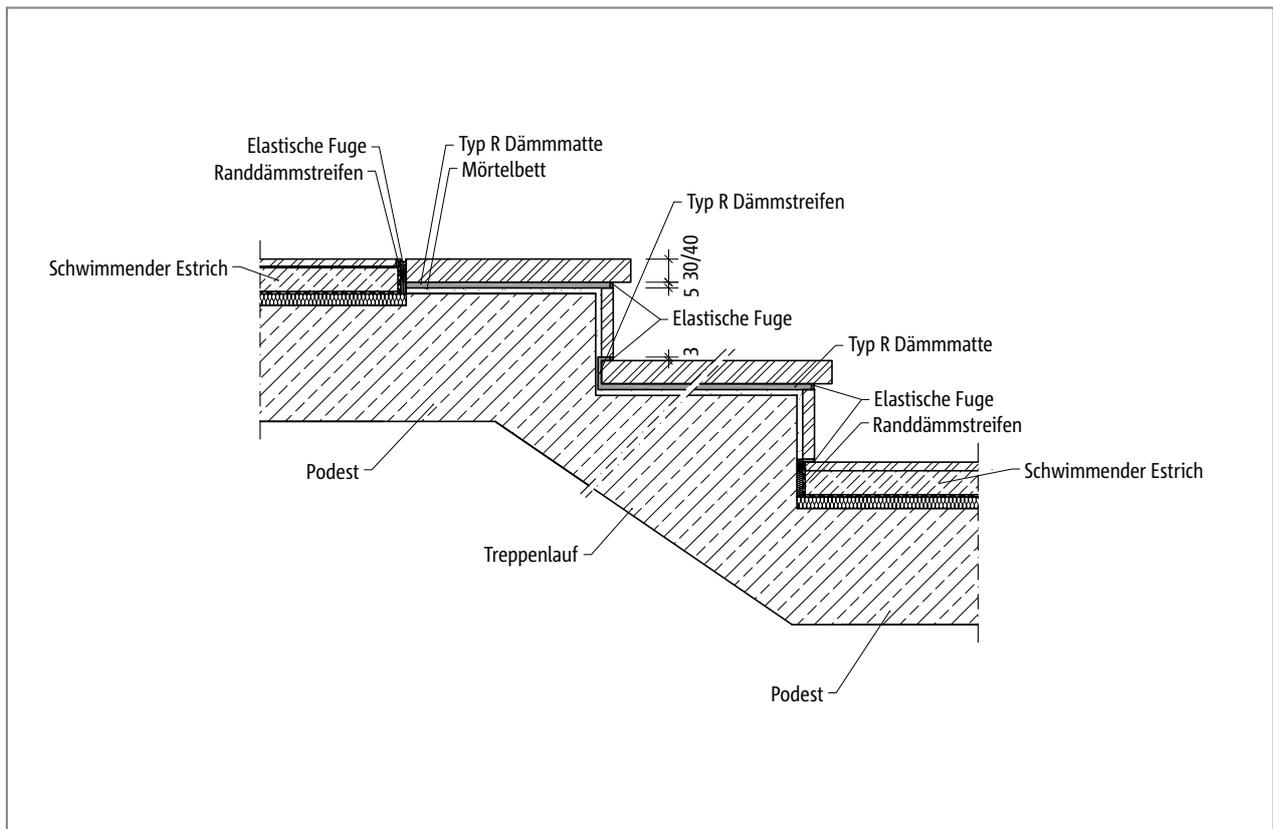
Schöck Tronsole® Typ R: Einbauschritt Treppenlauf
